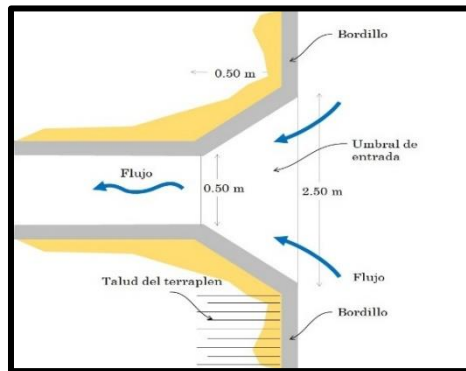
Vista en planta de la geometría de un lavadero tipo.
